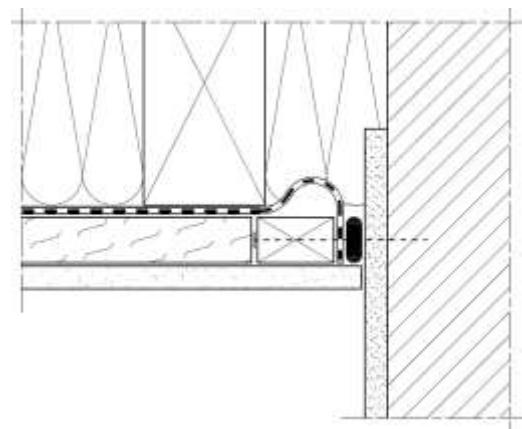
9: Beispiel für einen Anschluss an verputztes Mauerwerk, mit Pressplatte und Klebemasse
